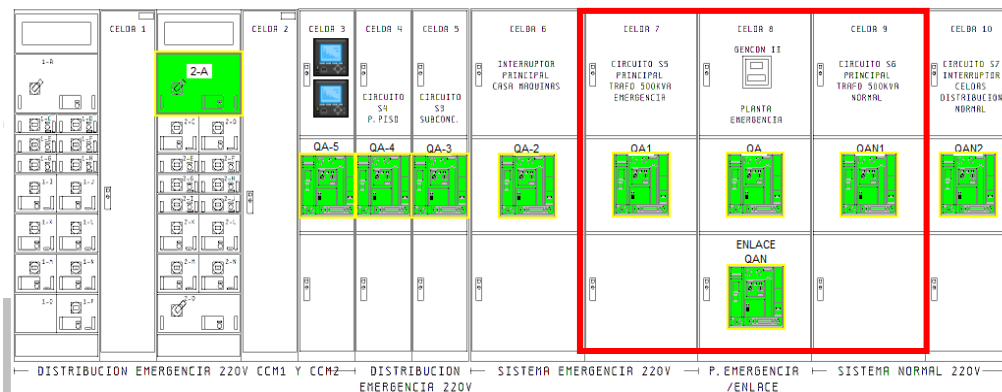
Dispositivos que componen la subestación eléctrica.
